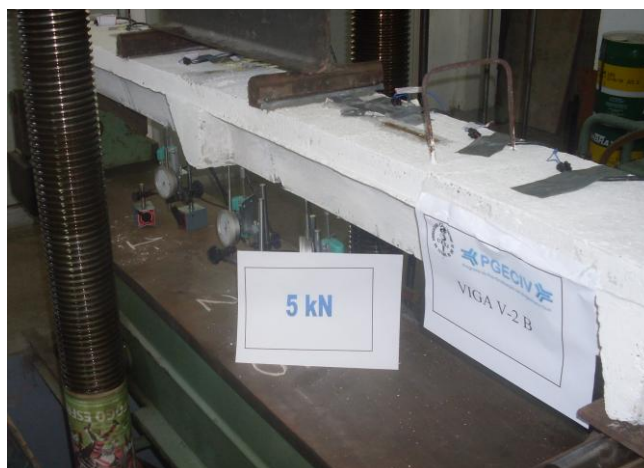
Detalhes da carga sem o aparecimento de fissuras na Viga V-2B
